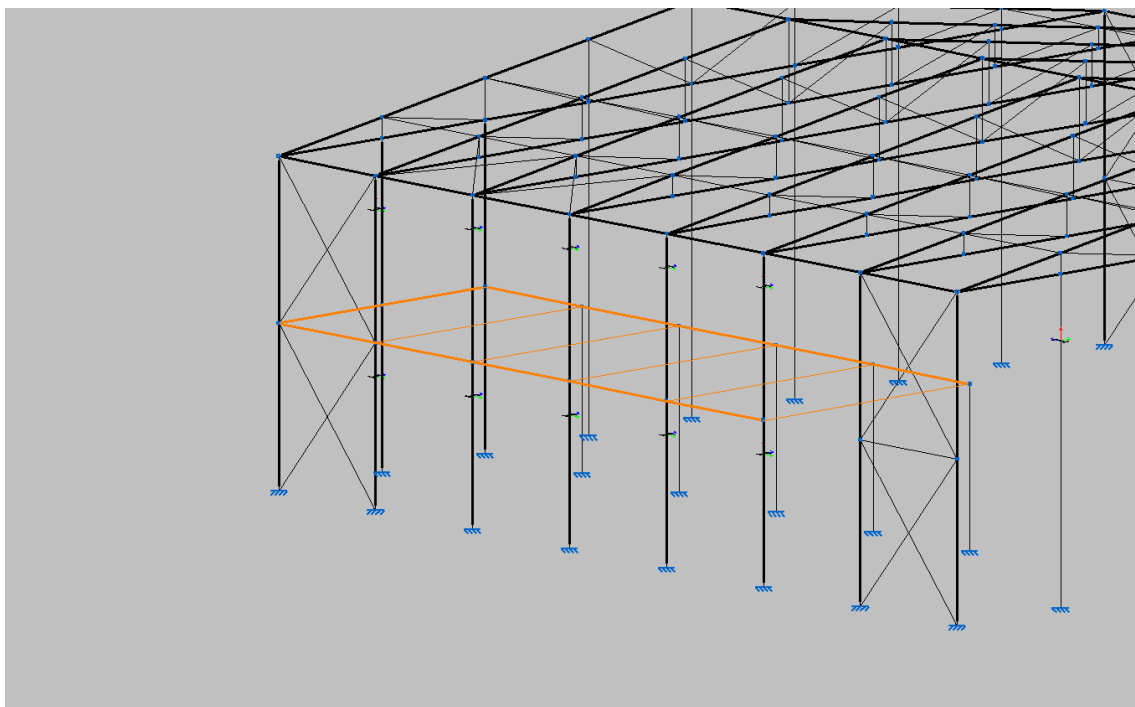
Vigas de atado identificadas de color naranja.
